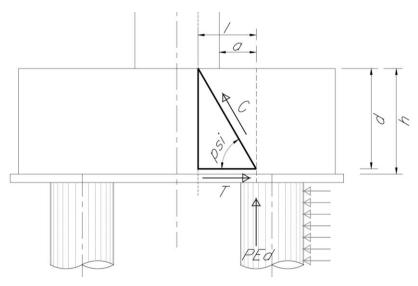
Tirante puntone - Biella compressa di calcestruzzo C e tirante di armatura T
